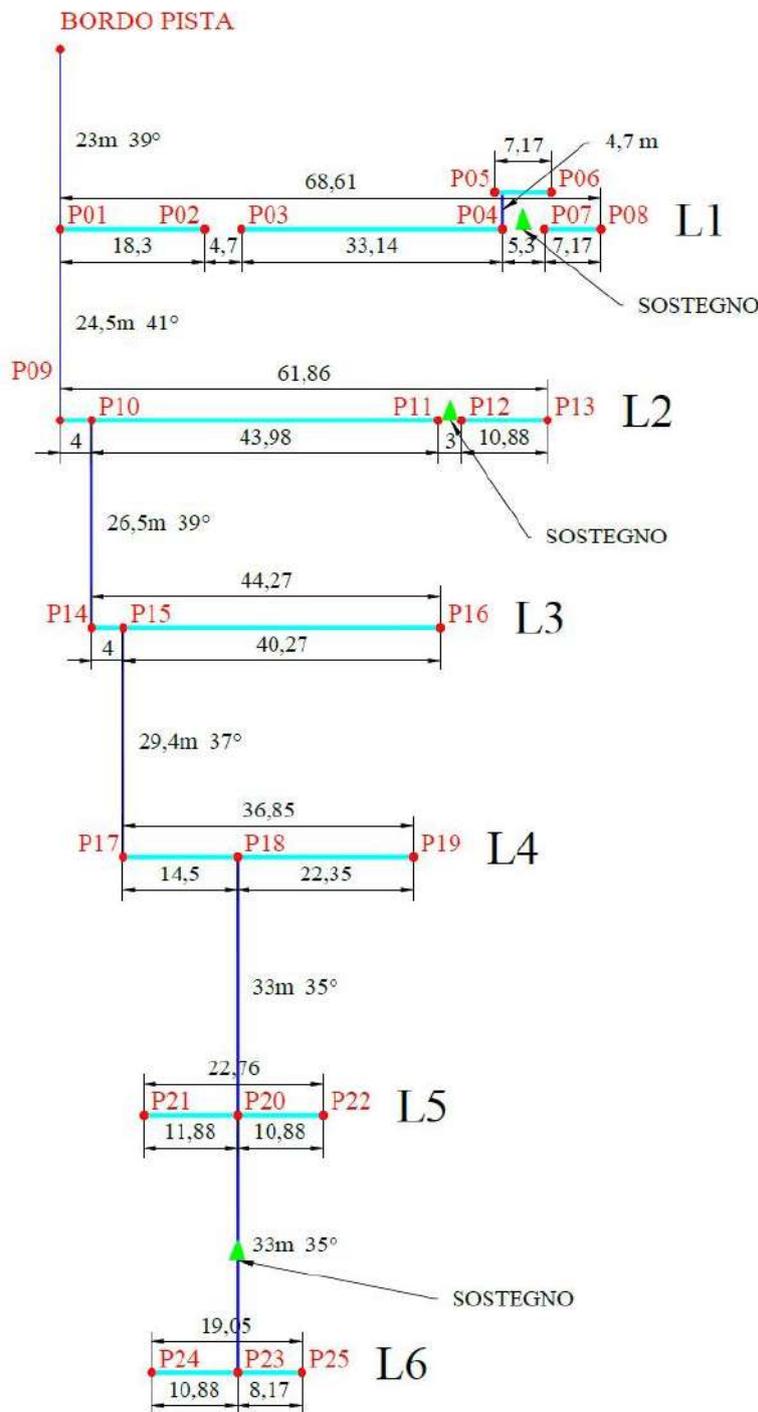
PLANIMETRIA DI TRACCIAMENTO
